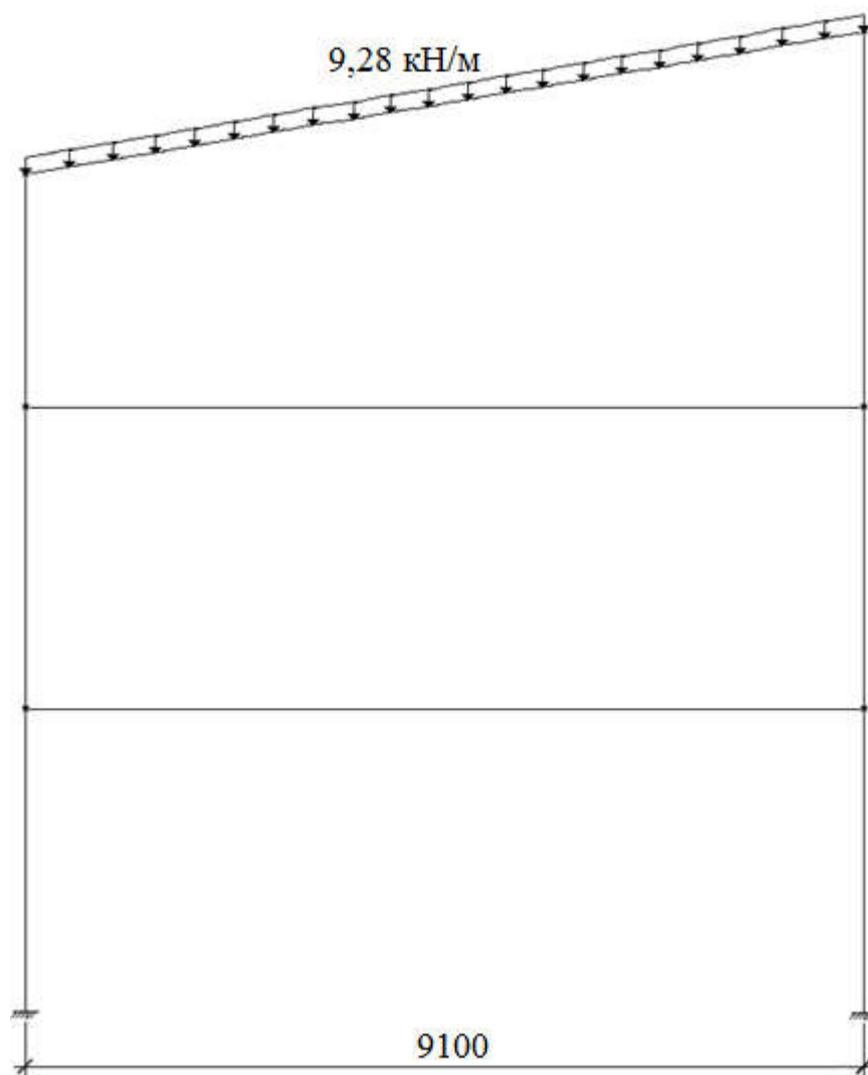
Снеговая нагрузка на раму на весь пролет
